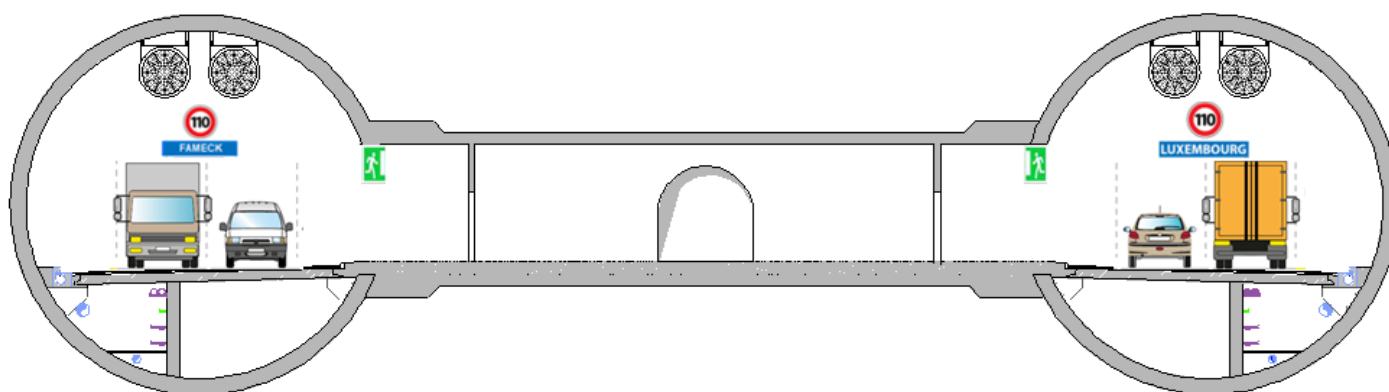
Profil en travers schématique du tunnel au droit d'un rameau d'interconnexion piétons
